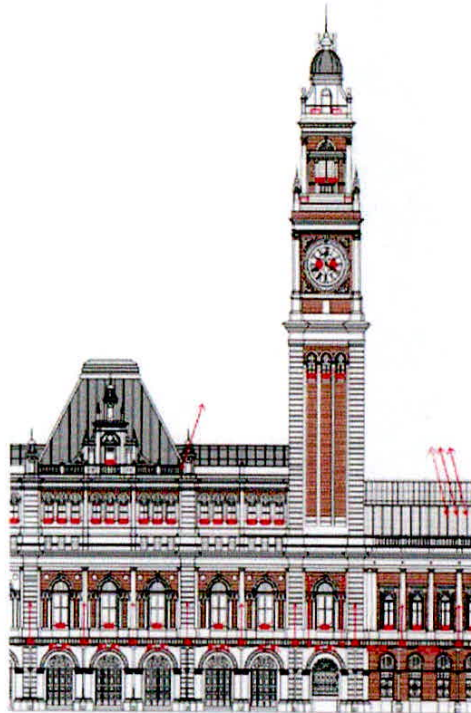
Elevação da fachada com a locação dos pontos de luz.
